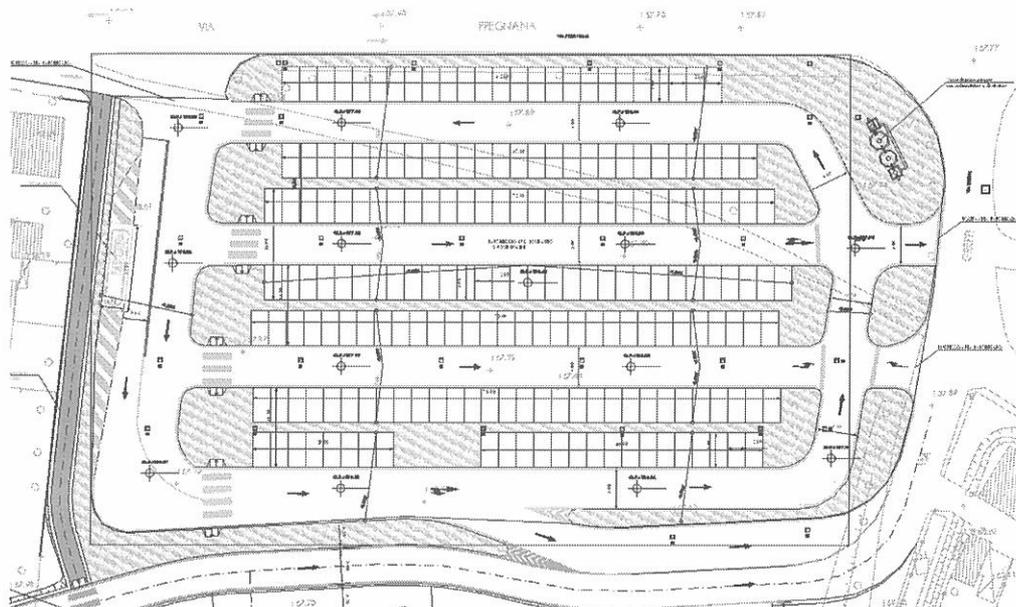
Stralcio planimetrico del parcheggio di Vanzago
